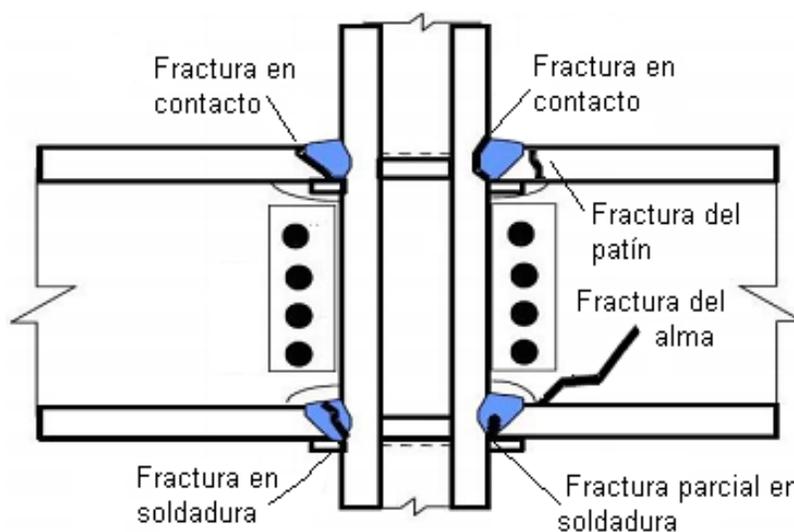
Fracturas en elementos de acero. (Modificado de SAC Joint Venture, 2000 recuperado de Najarro, 2008)
